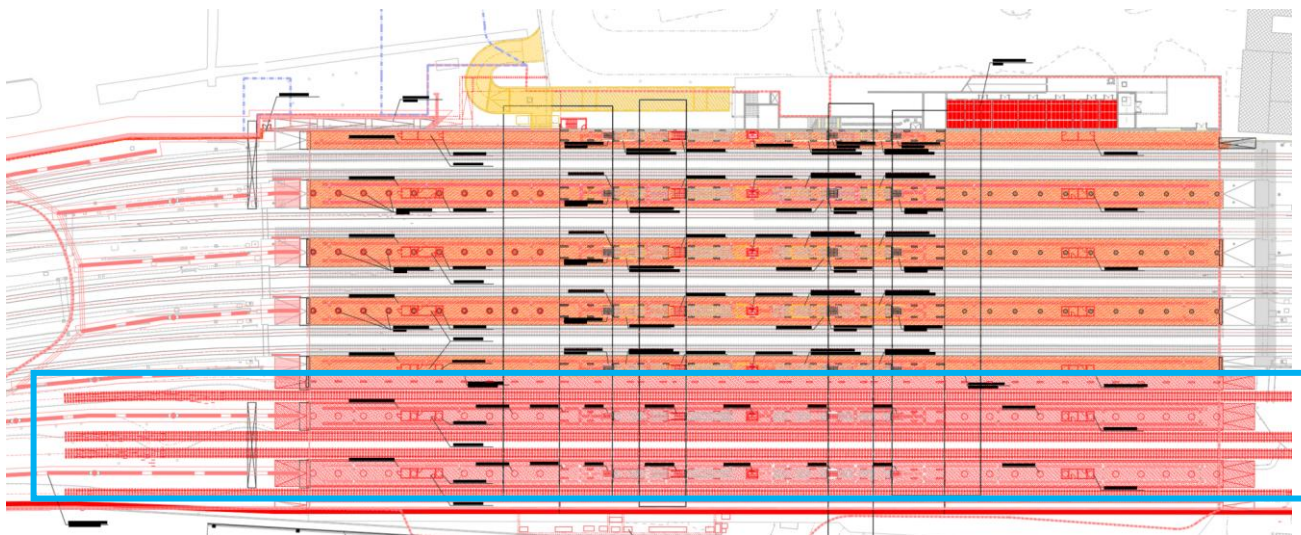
Planimetria generale stazione di Bovisa con indicazione dell'ampliamento.
